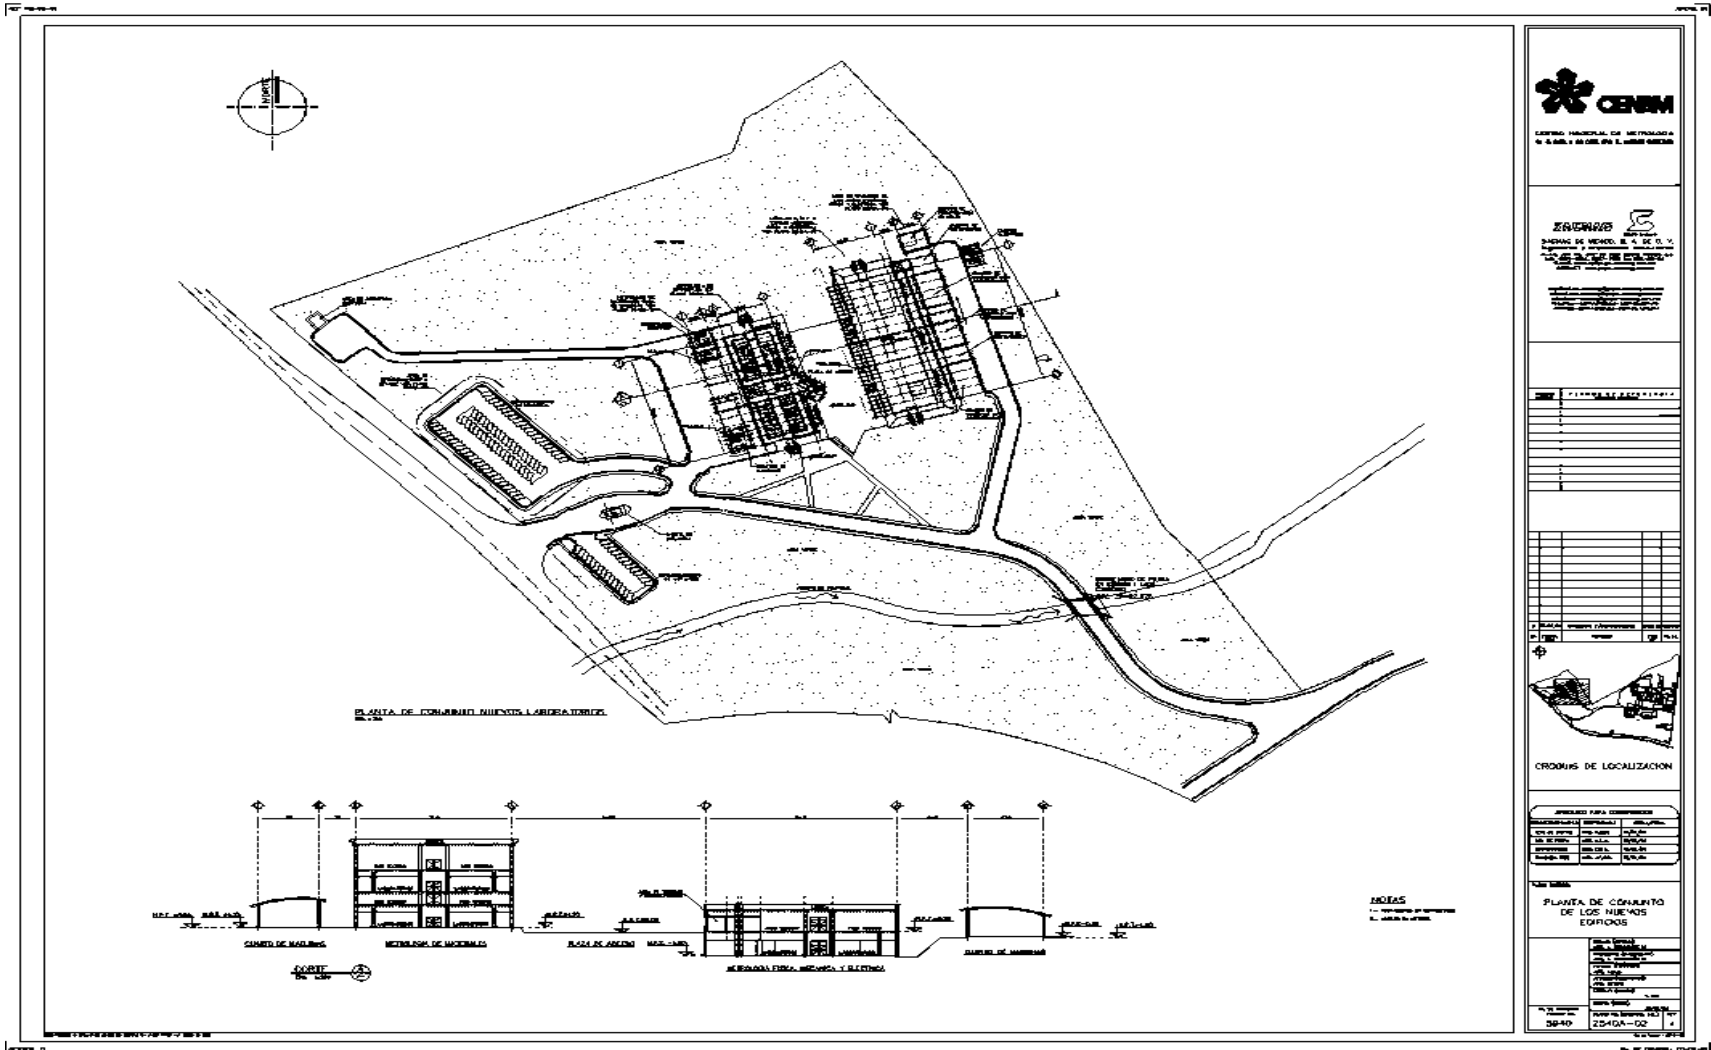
PLANTA DE LABORATORIOS MÓDULO A B C D E
